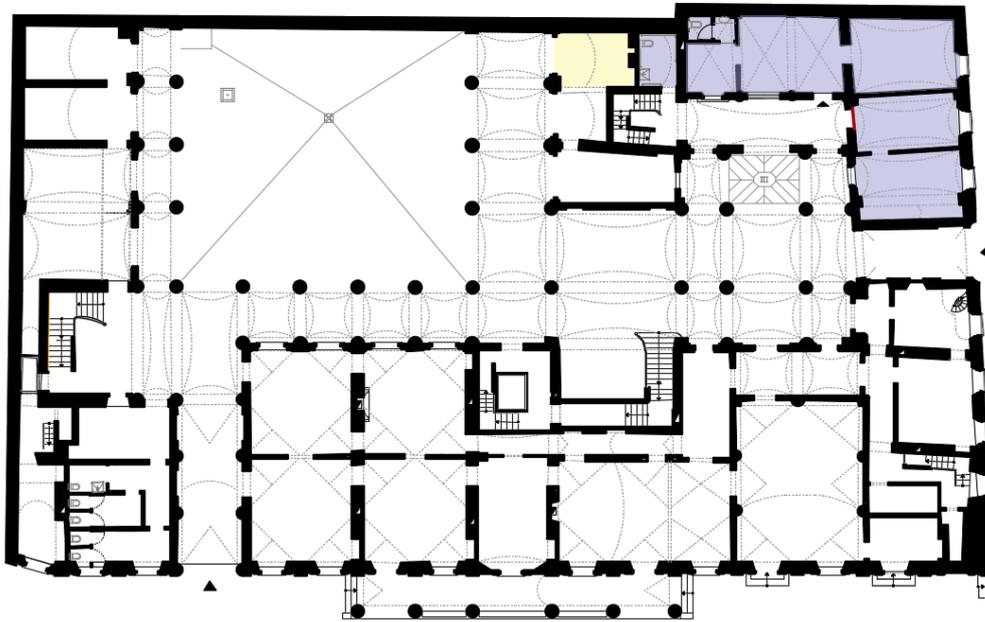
Pianta piano terra. Area di distribuzione della UTA 1.
